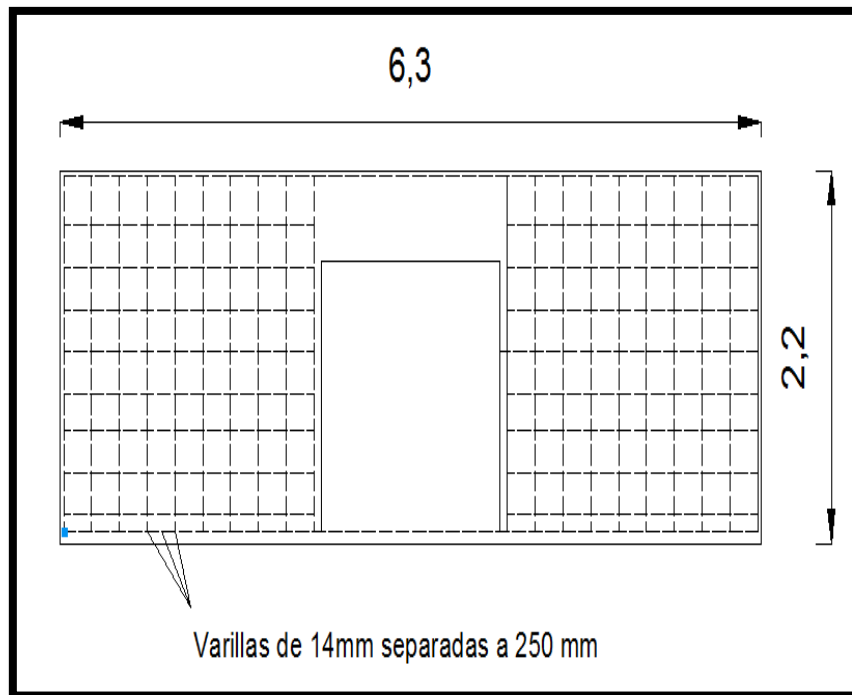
Elevación frontal de cabezal para alcantarilla de cajón.
